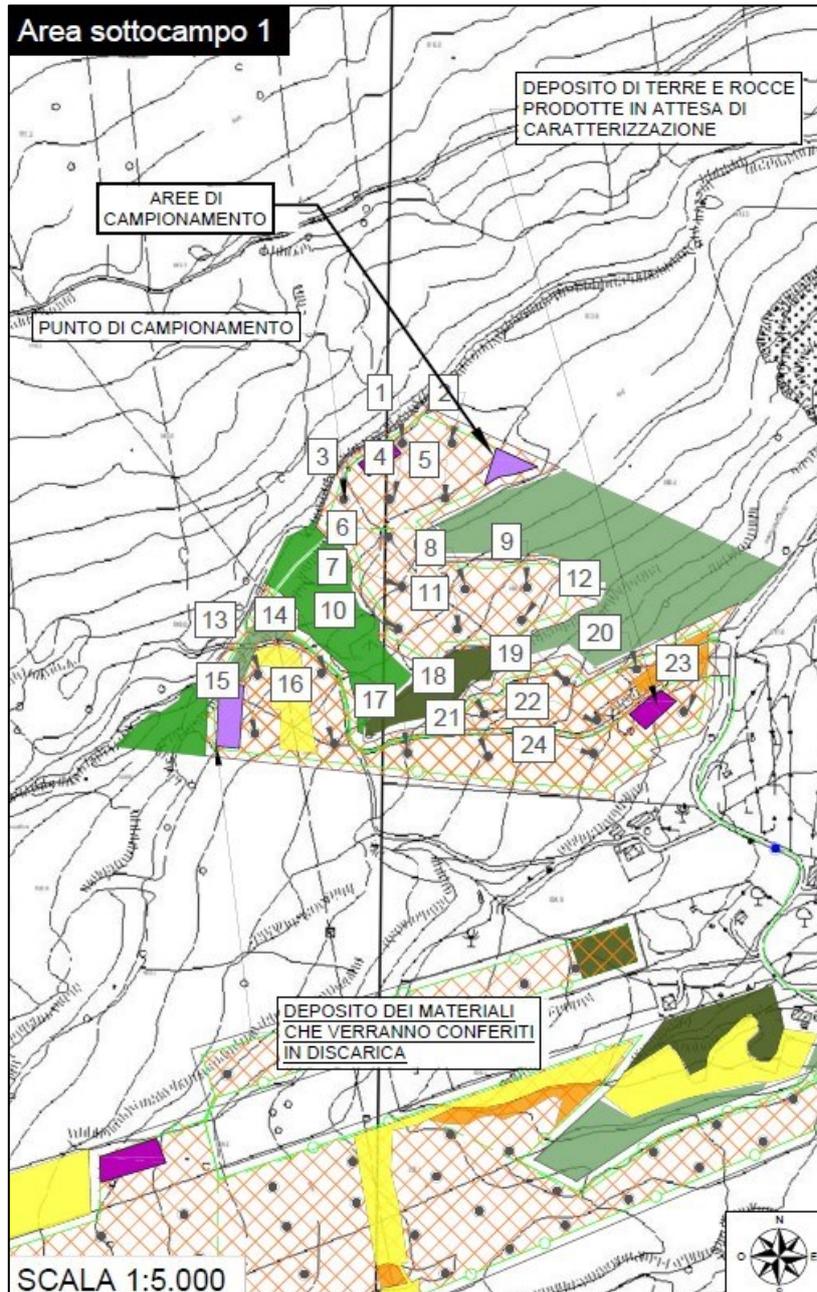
Planimetria sottocampo 1 con punti di campionamento
